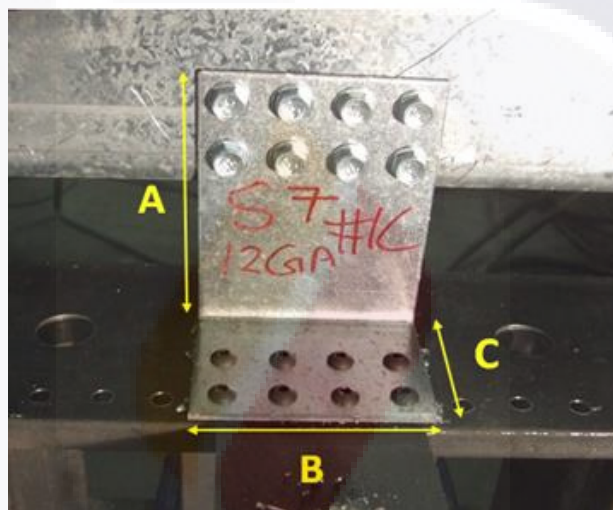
Dimensiones de clips conectores en la prueba a compresión.
